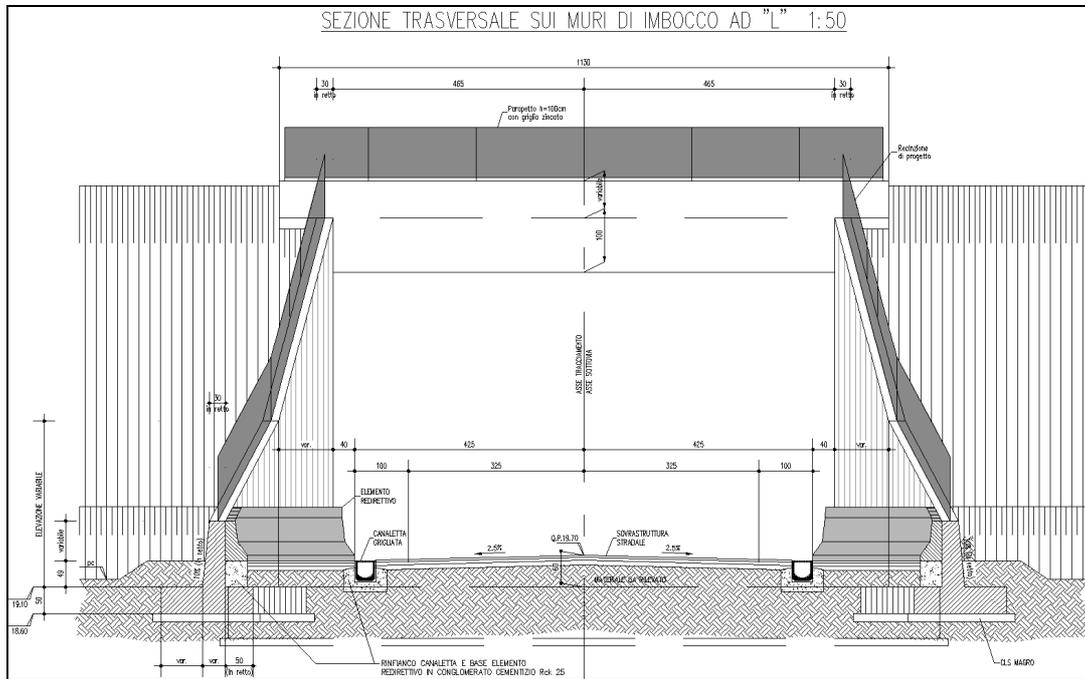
SEZIONE TRASVERSALE SUI MURI DI IMBOCCO AD "L"
